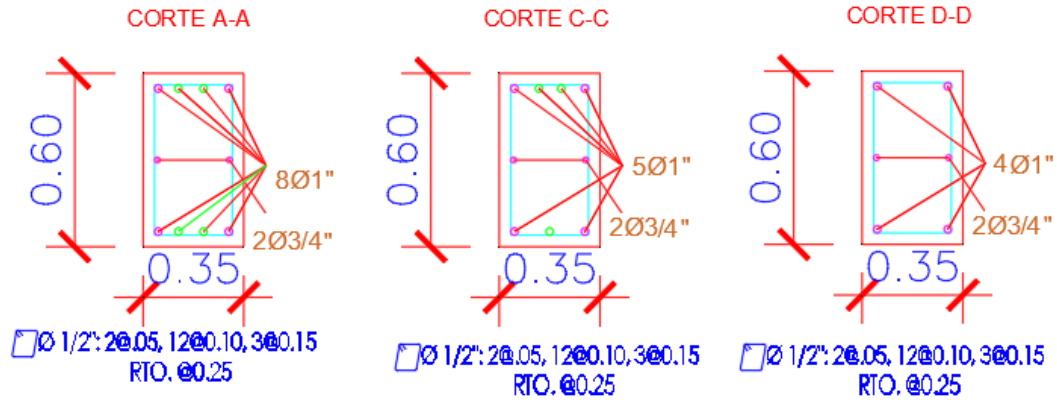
Secciones de Viga con Refuerzo 4° Piso
